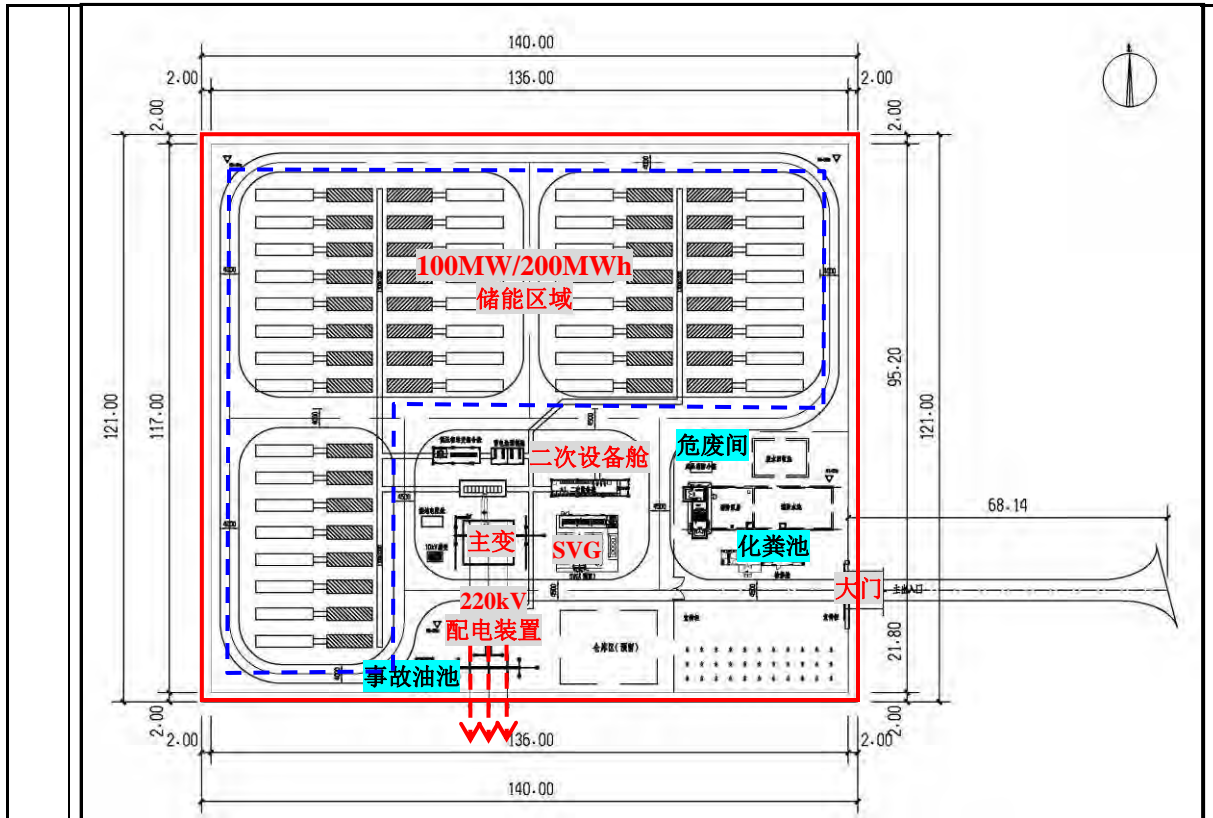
本工程 100MW/200MWh 储能电站平面布置示意图
